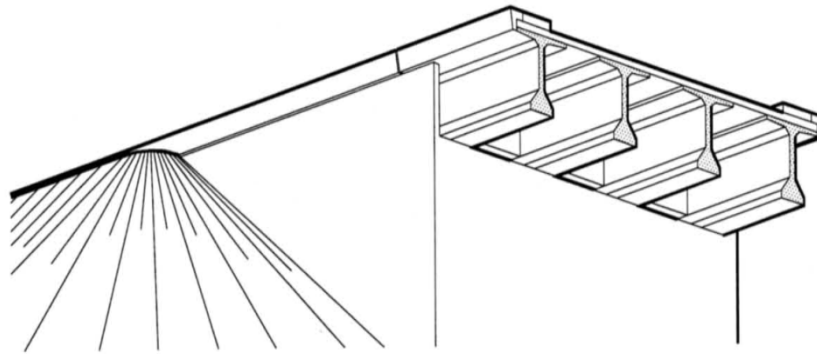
Pont à Poutres VIPP avec Entretoises
